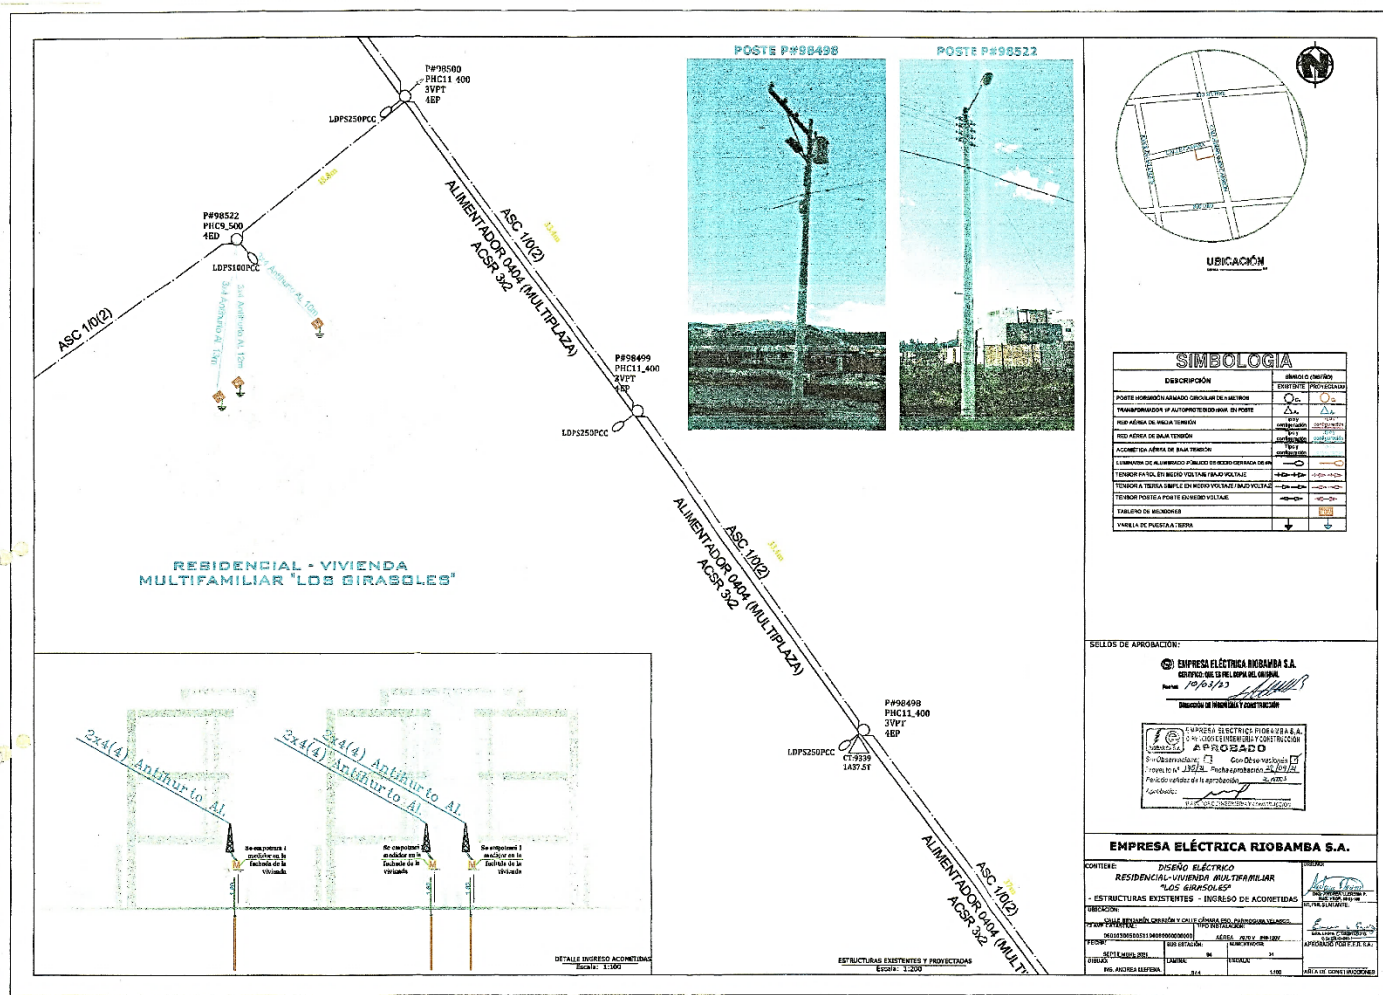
Plano instalaciones Eléctricas(estructuras existentes y acometidas)
